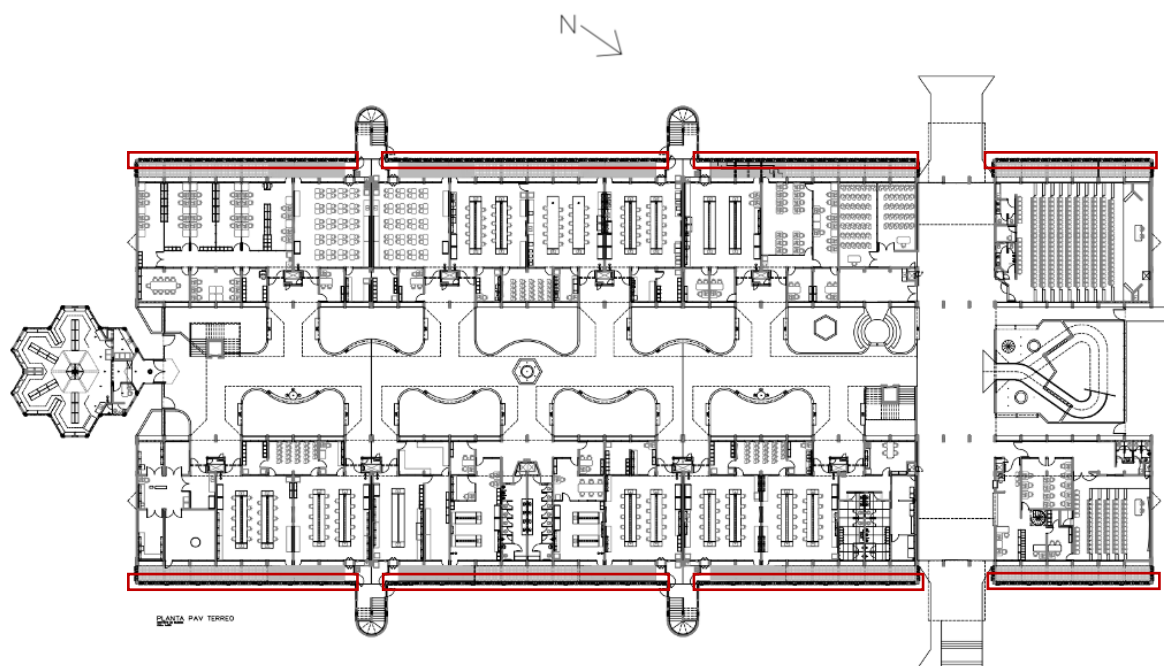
Instituto de Química da Universidade de Brasília DF: Planta do pavimento térreo.
